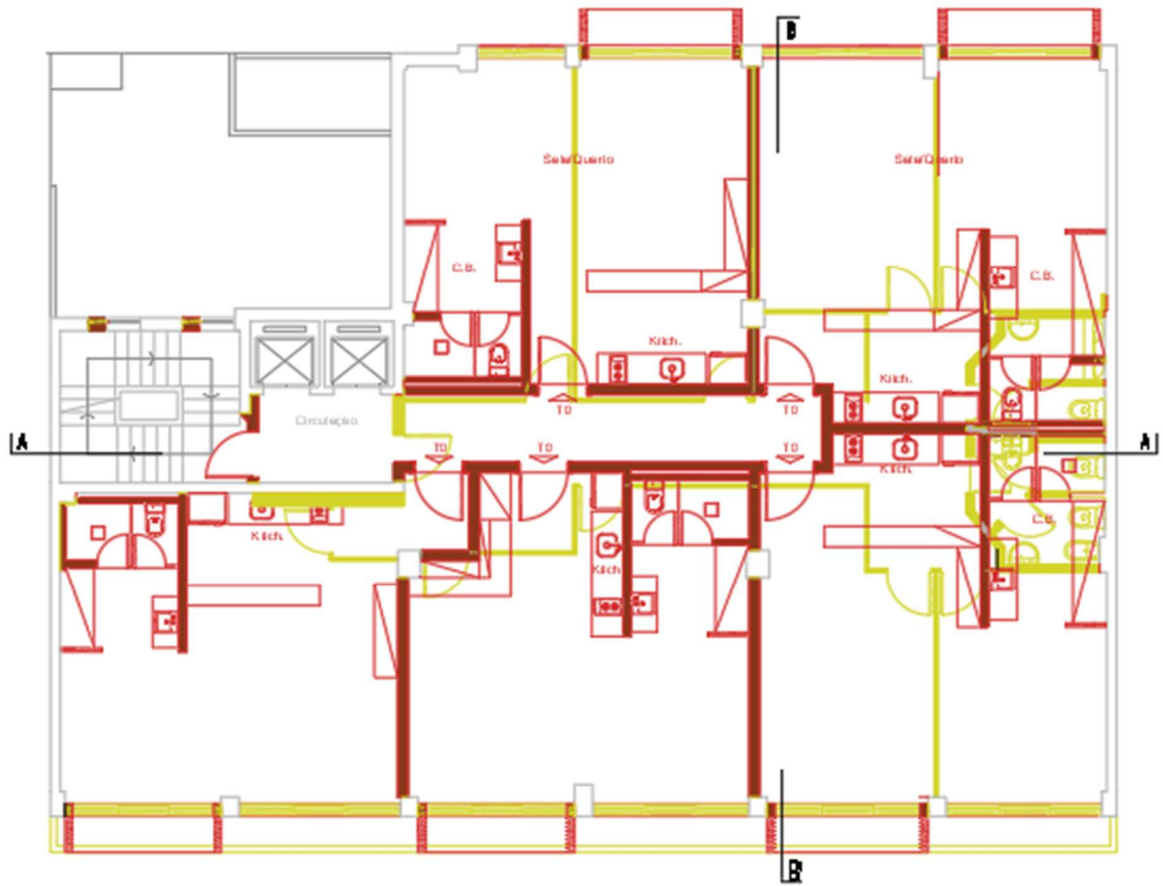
Proposta para a planta do 1º piso ao 5º piso, (piso tipo).
